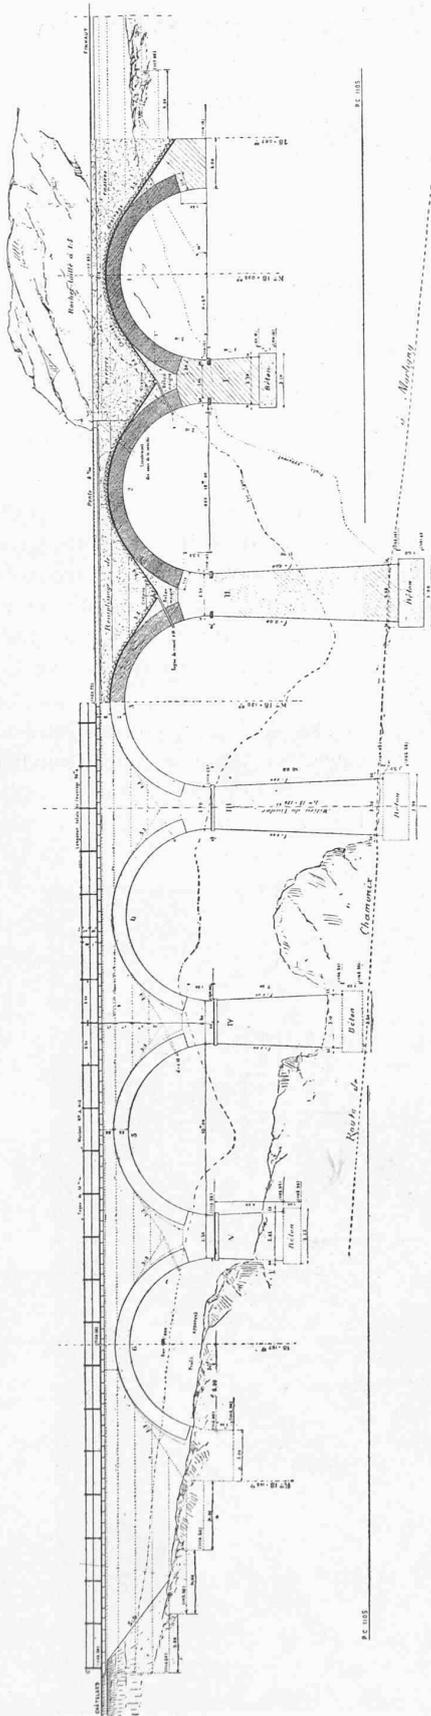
Viaduc de la Scierie, au Châtellard. — Elevation et coupe longitudinale.
